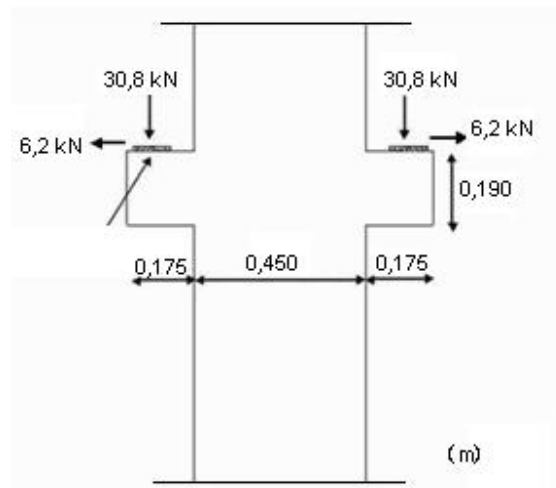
Corte na zona do pilar e da consola curta na direcção X
